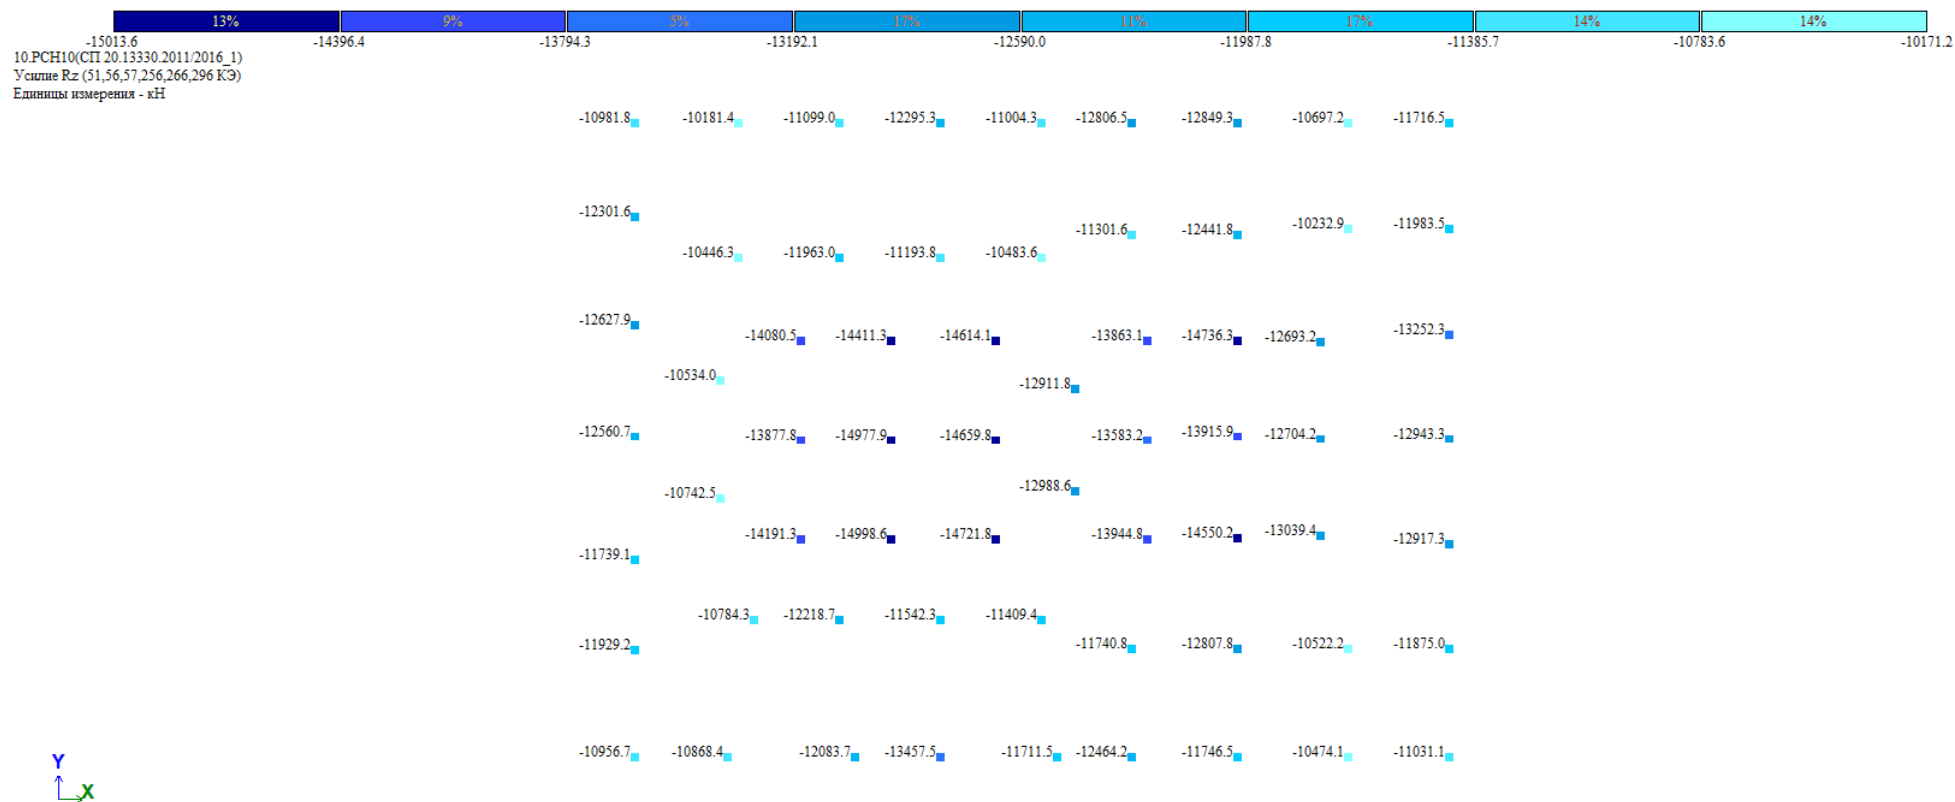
Расчётные нагрузки на оголовки свай в корпусе 2. Максимальная расчётная нагрузка на сваи в К2 14999 кН
